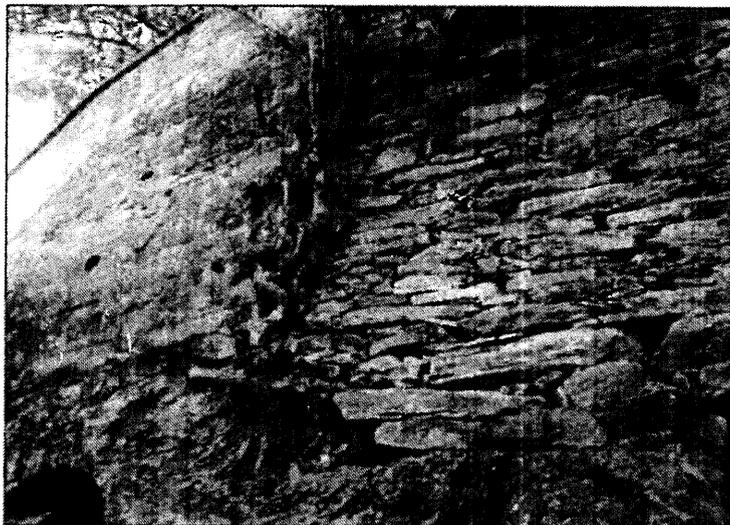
Vista geral para o muro de arrimo constituído de concreto ciclópico e pedra seca. Notar o muro de alvenaria convencional assente sobre a estrutura de contenção.
